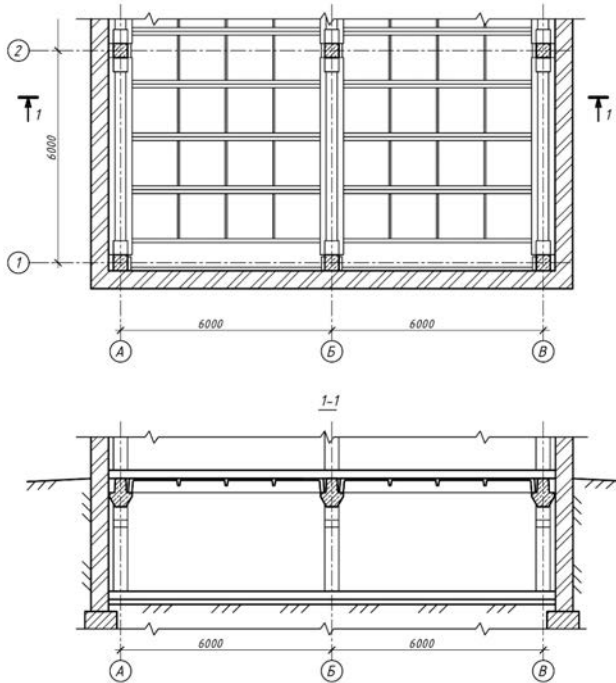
Фрагмент плану перекриття будівлі (вигляд знизу) та її розріз на рівні підвального поверху
